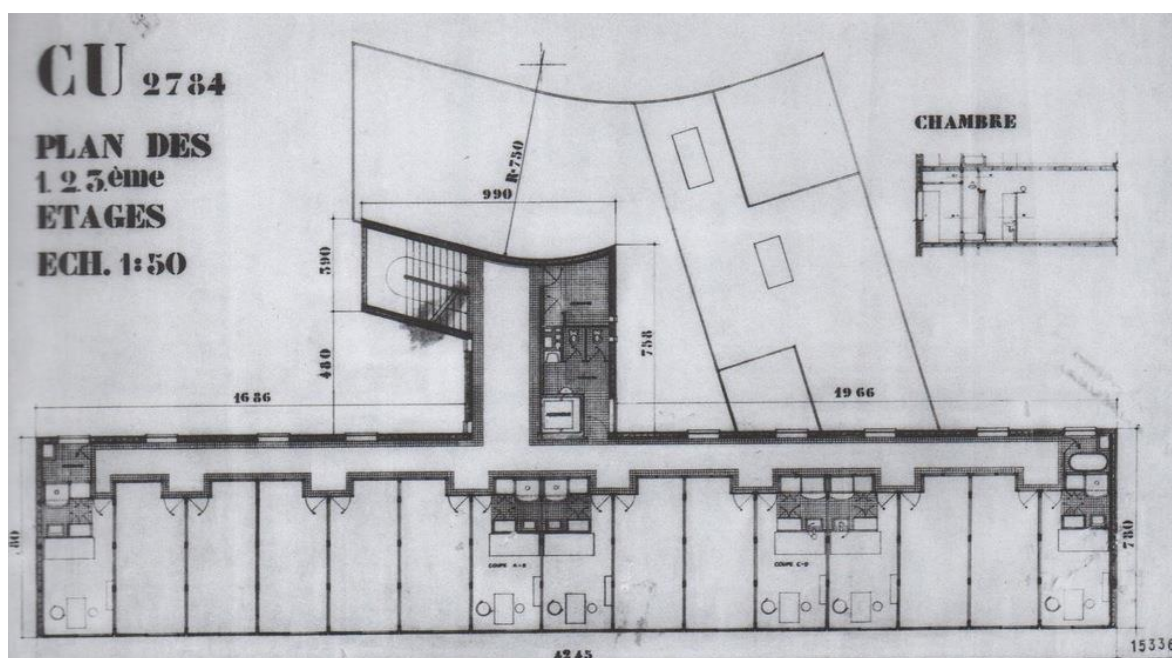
Pianta piano tipo - Fonte: www.architect.com
